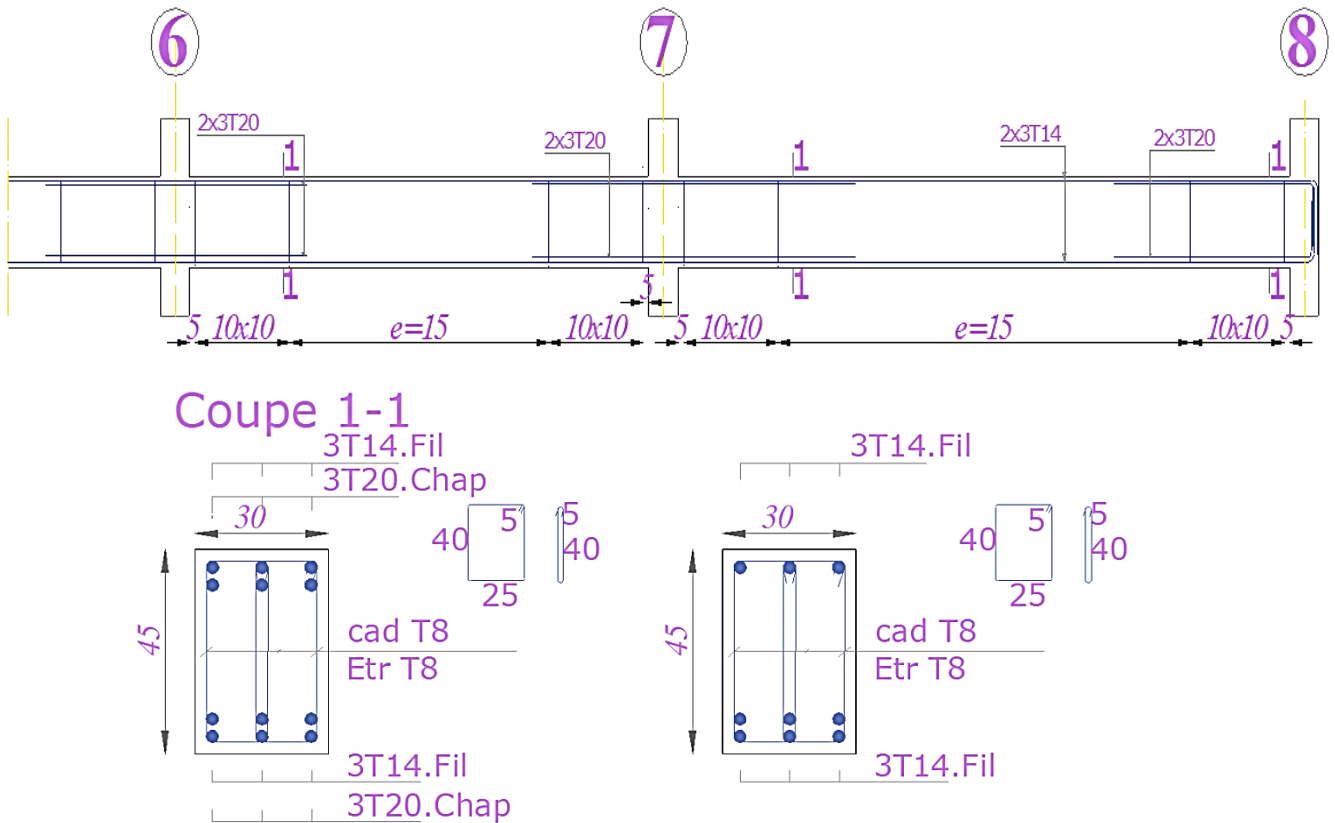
5: Schéma de ferrailage d'une poutre secondaire –la plus sollicitée-
